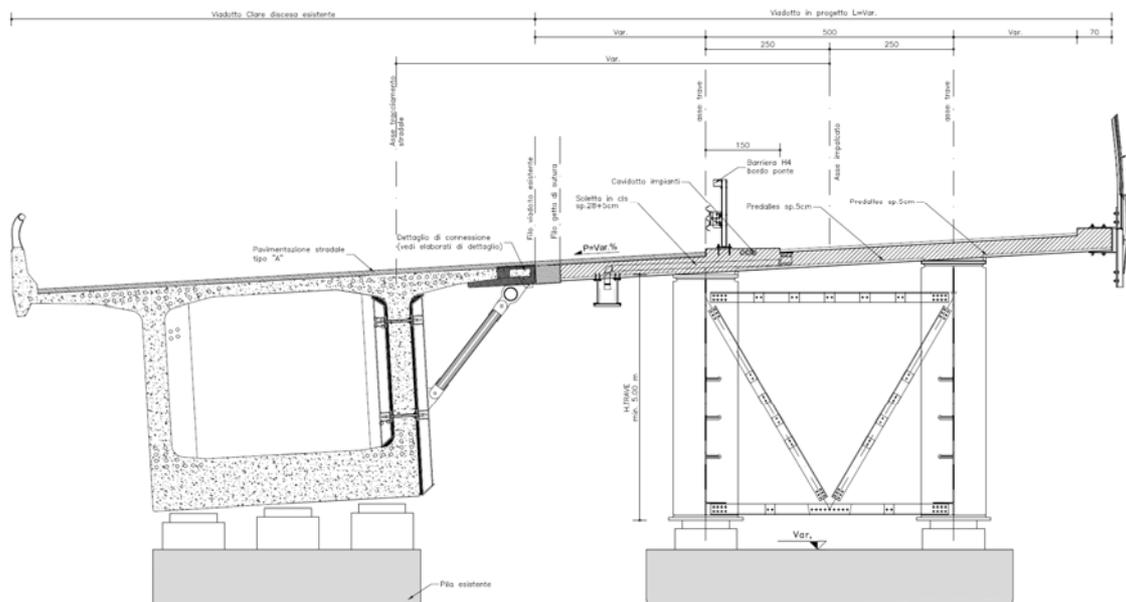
Viadotto Allargamento Discesa – tratto solidarizzato – sezione su Pila IP2-IP5
